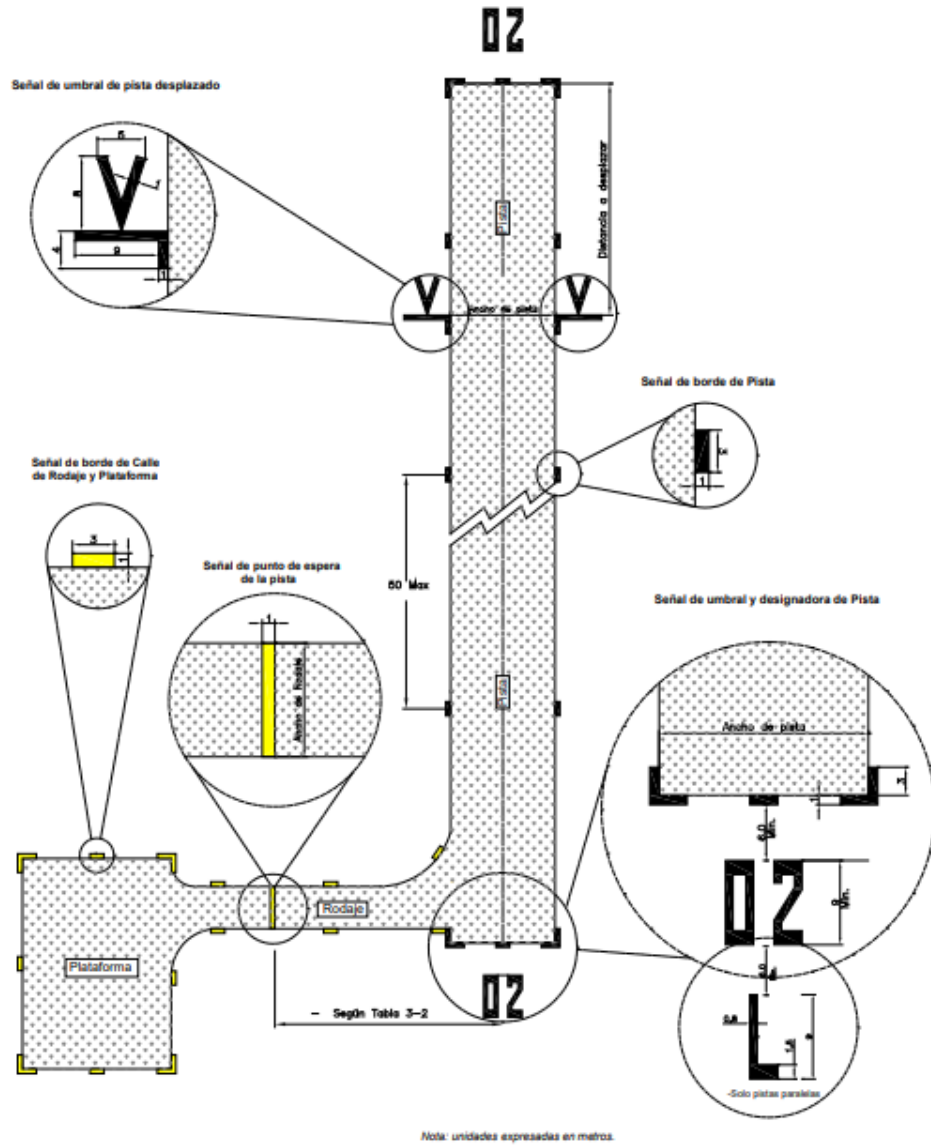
Distribución de señales diurnas en pistas no pavimentadas
